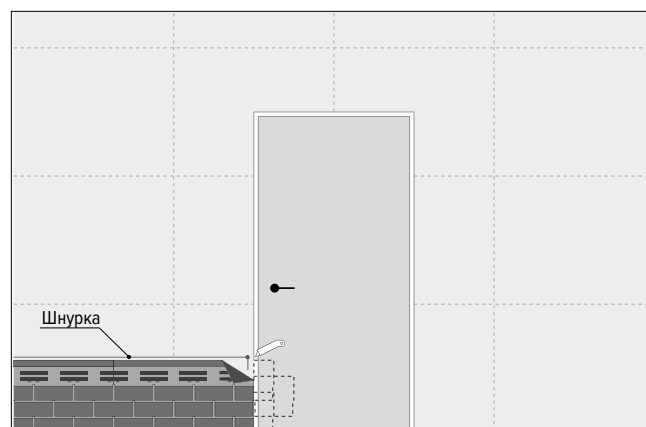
Монтаж фасадной плитки вокруг дверных проемов
